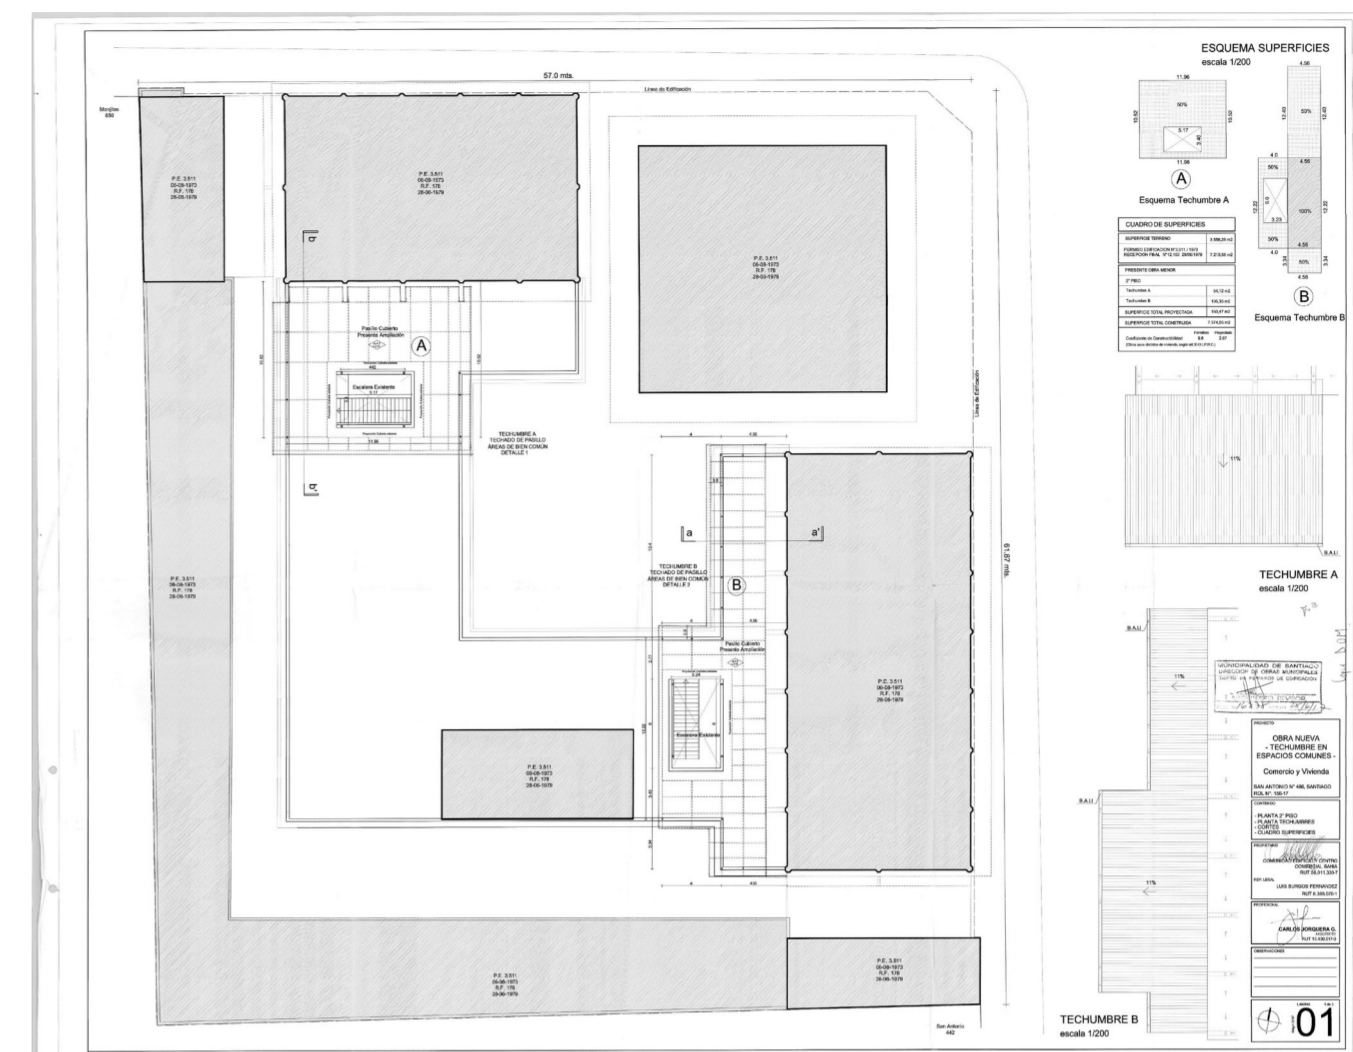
Archivo Plano Municipal. Planta de superficies.
